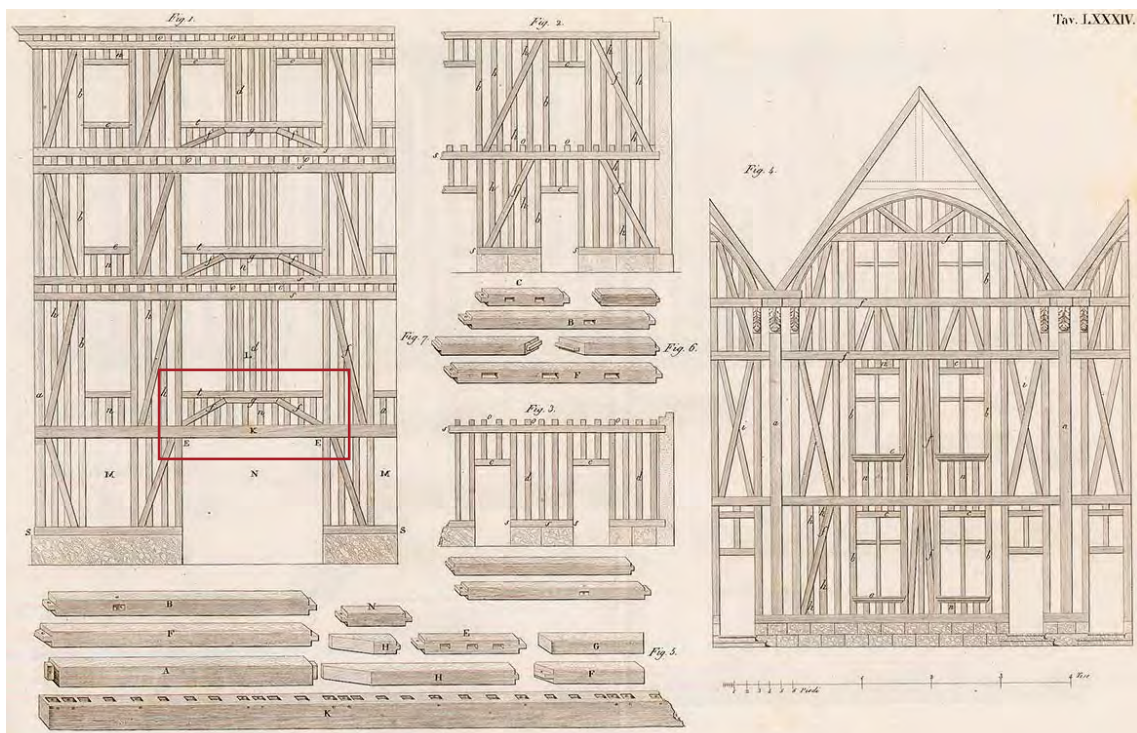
Parapetto proposto dal Rondelet. ©Rondelet, G.
